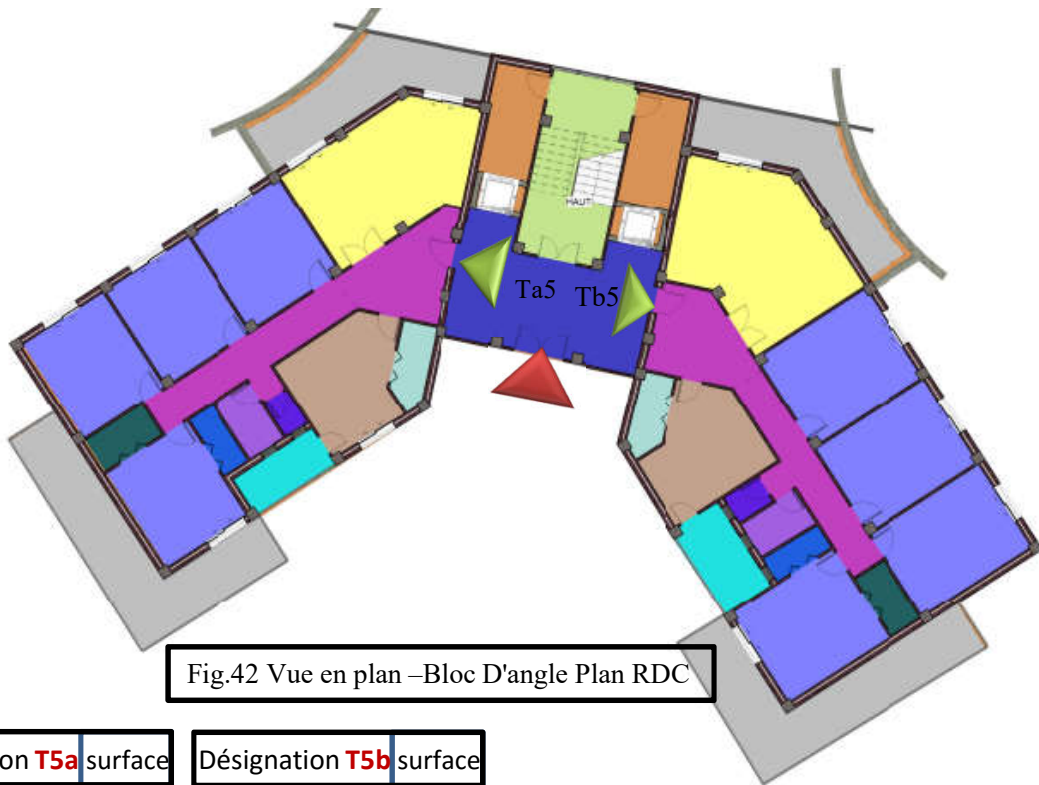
Vue en plan –Bloc D'angle Plan RDC
